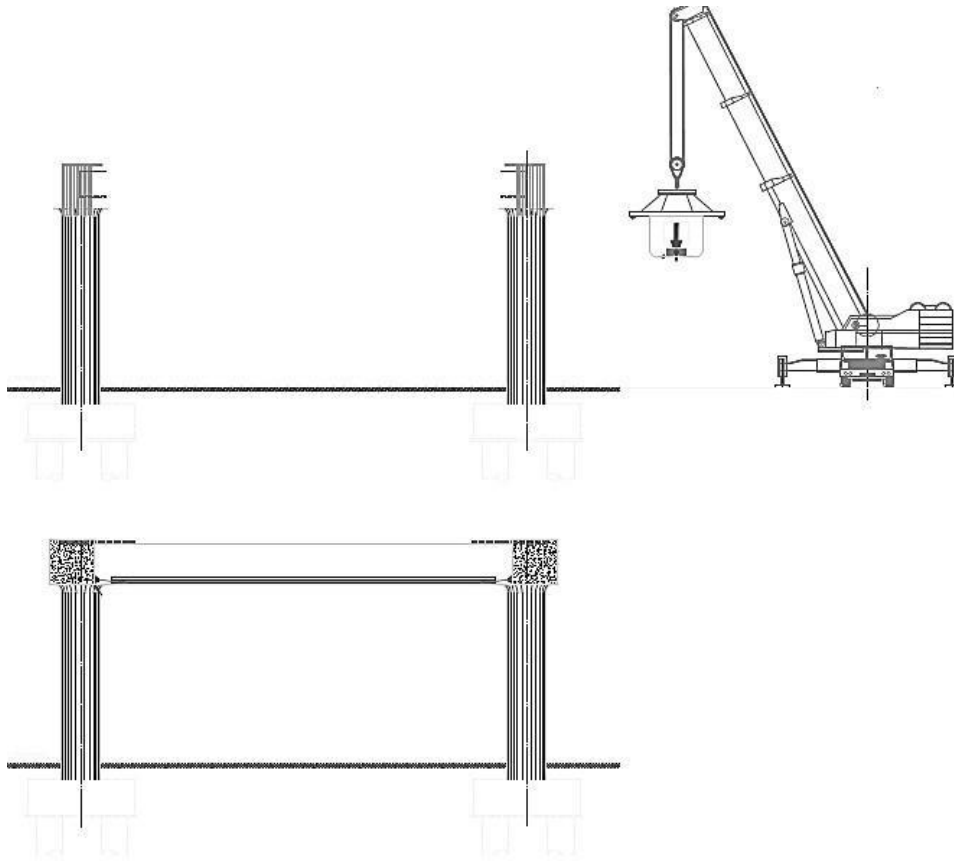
Instalación de la viga prefabricada mediante grúa
